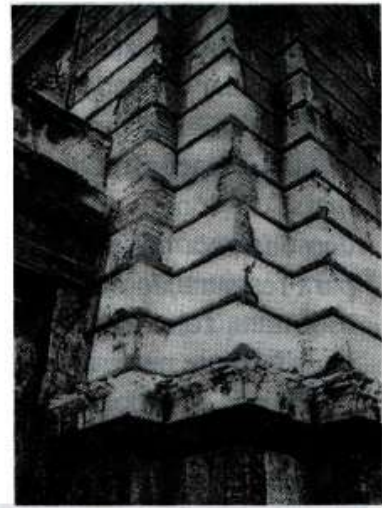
Descolamento e desagregação do revestimento em fachadas
